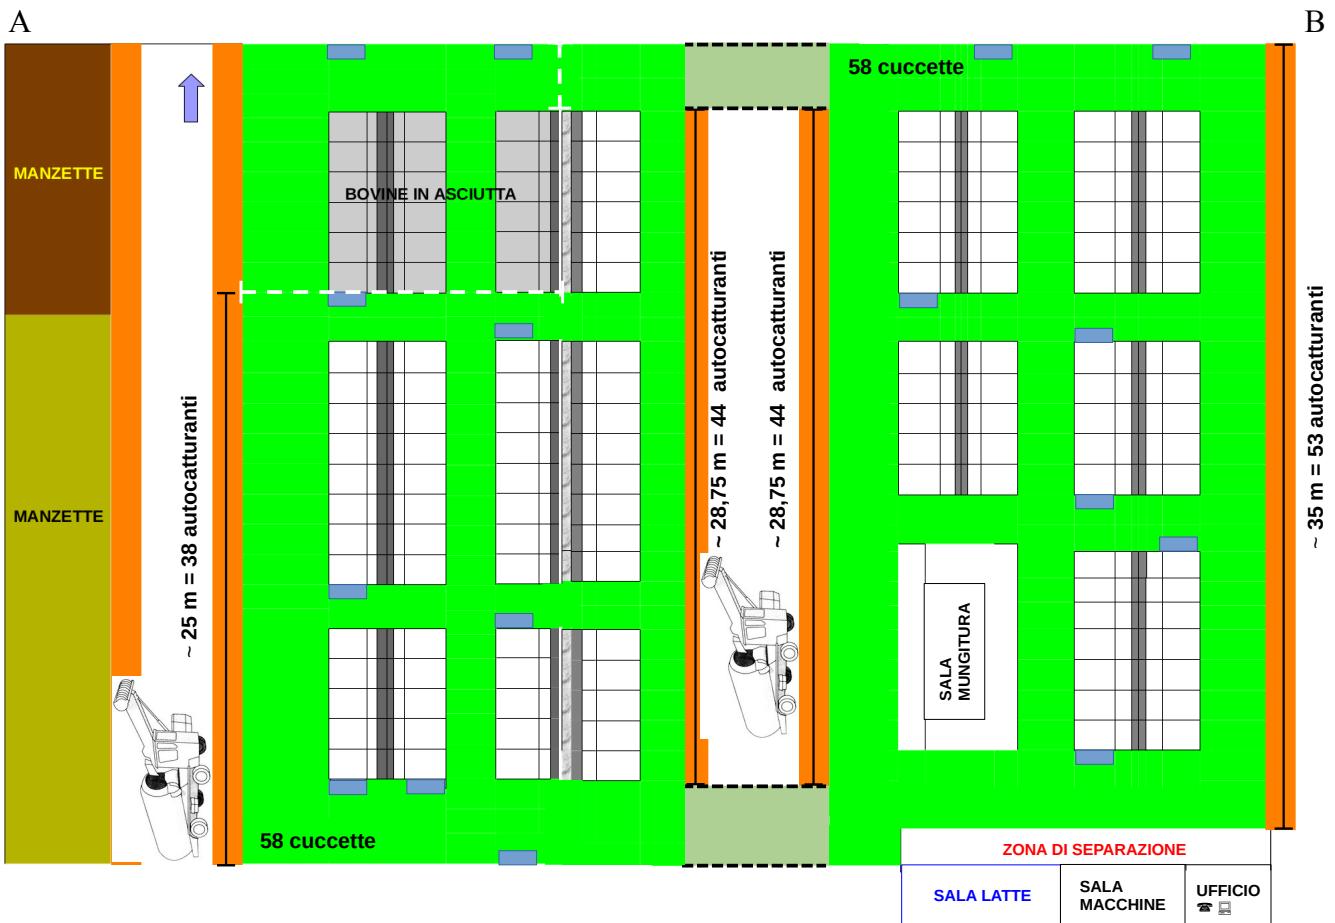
Planimetria schematica di una moderna stalla da latte: soluzione che evita la competizione alimentare.
